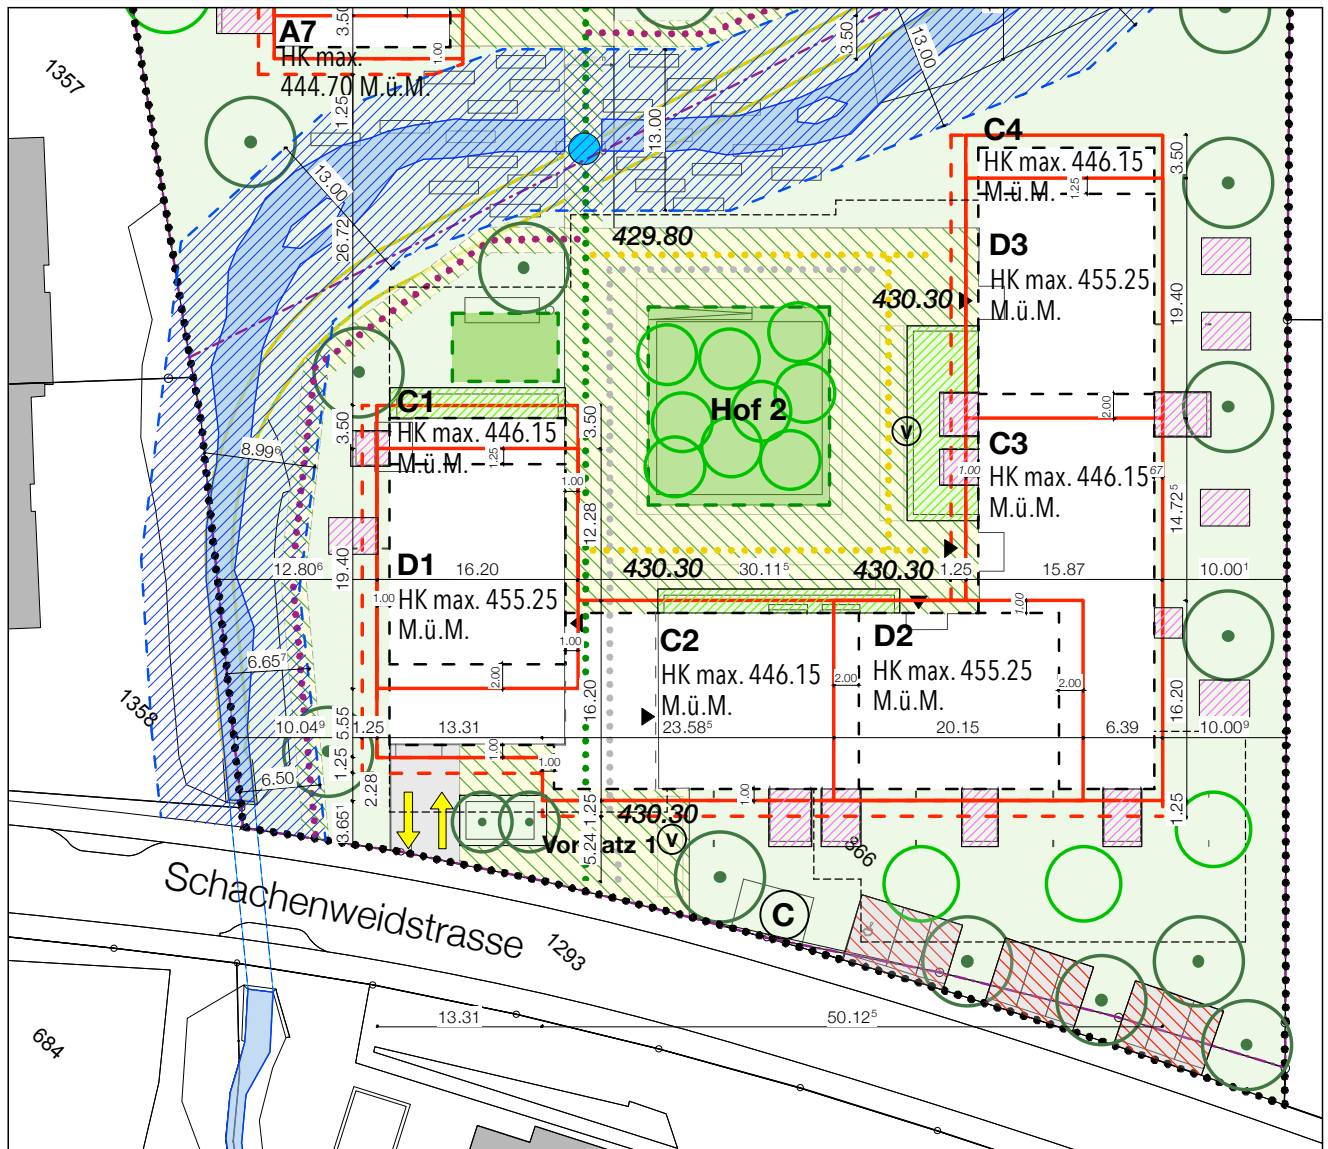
Ausschnitt des Situationsplans 1:500 Bebauungsplan Sagenmatt mit den Baufeldern C1-C4 und D1-D3
